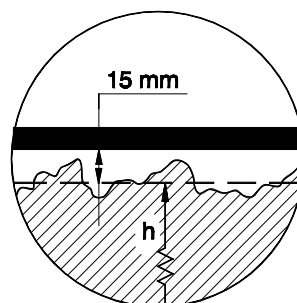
c - Verankering van de hoofdwapening met verankeringswapening op de breedplaten ter plaatse van een tussenoplegging:
